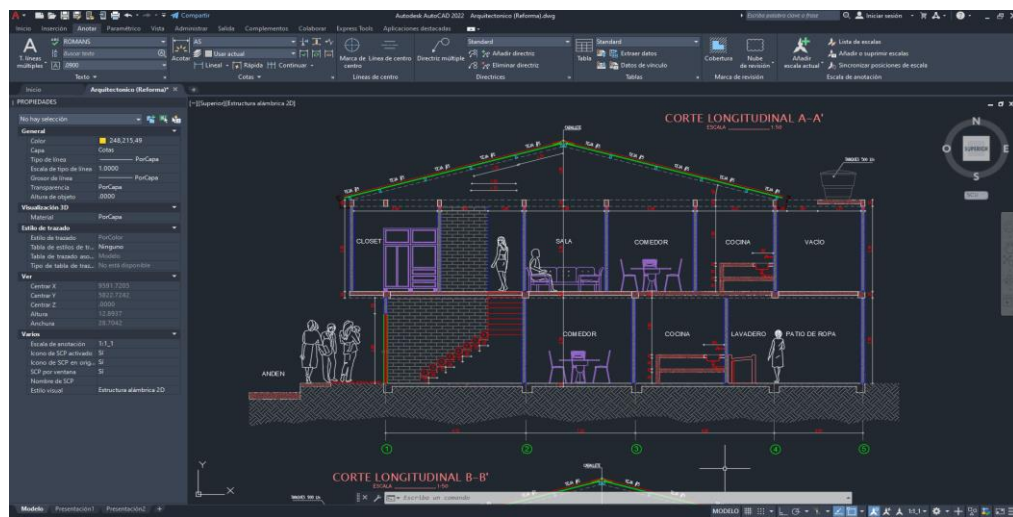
Plano corte longitudinal. AutoCAD. Fuente elaboración propia.
